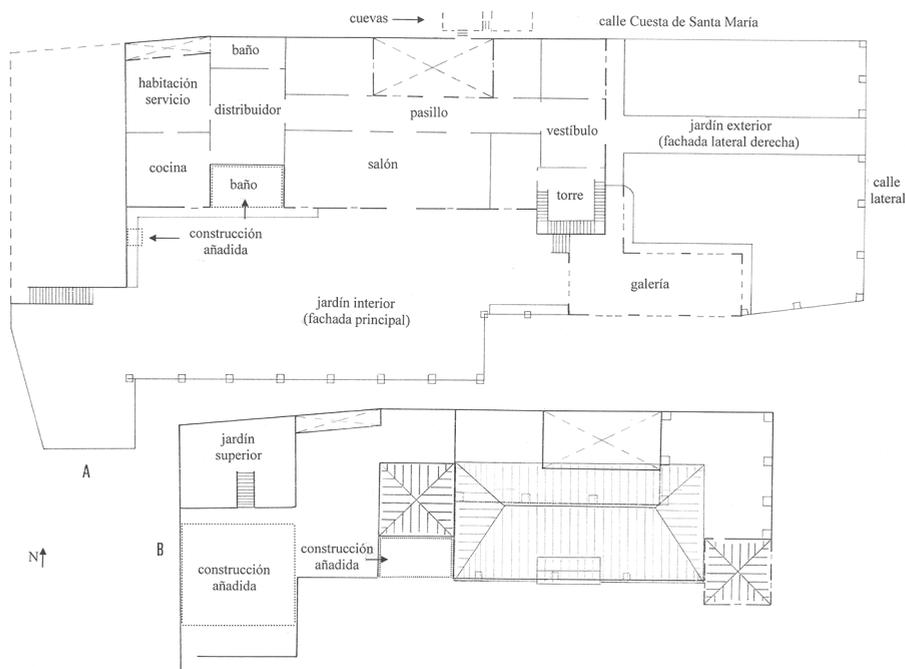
Villa Esperanza. Plano de la planta baja (A). Plano de la planta superior y cubiertas (B). (Elaboración propia).
